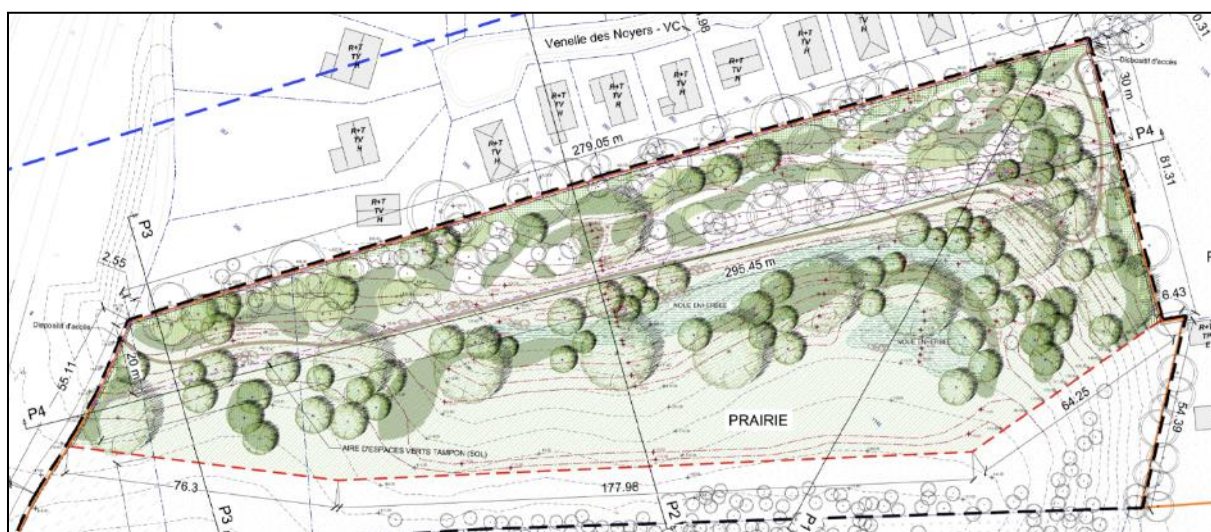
Plan d'aménagement projeté dans la zone tampon (source : assar architects)
